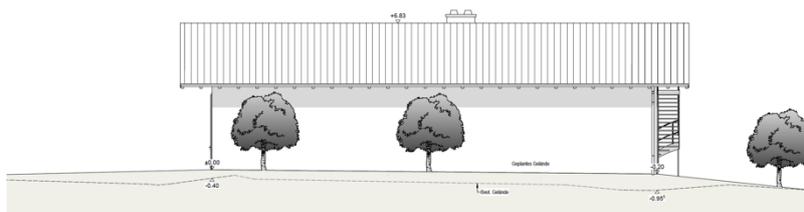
Ansichten Heizhaus, Planstand: Entwurfsplanung 16.12.22
